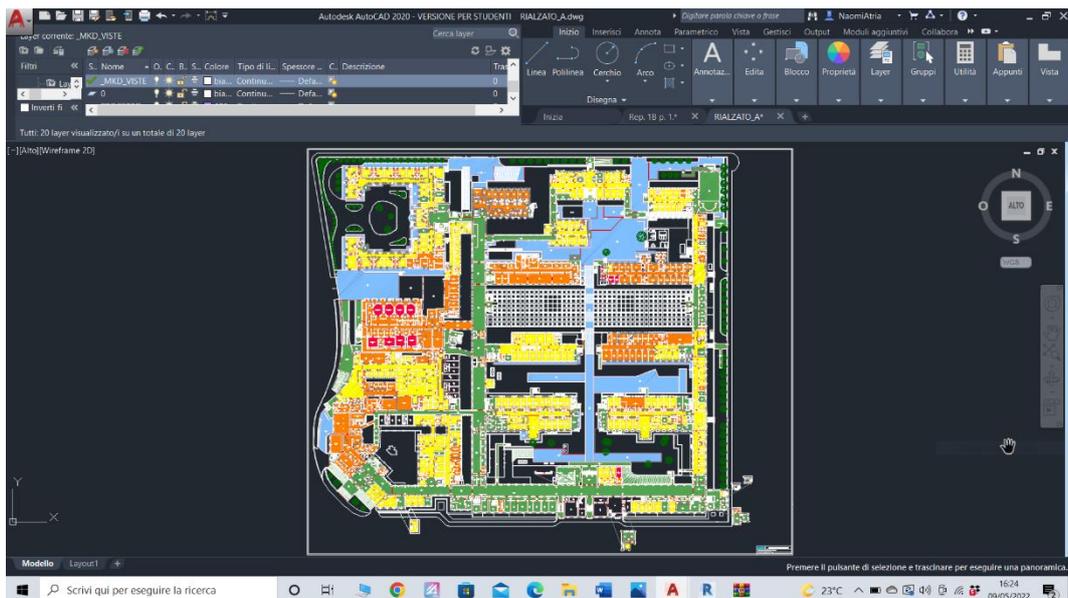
Planimetria generale complesso Ospedaliero Mauriziano, piano A.
